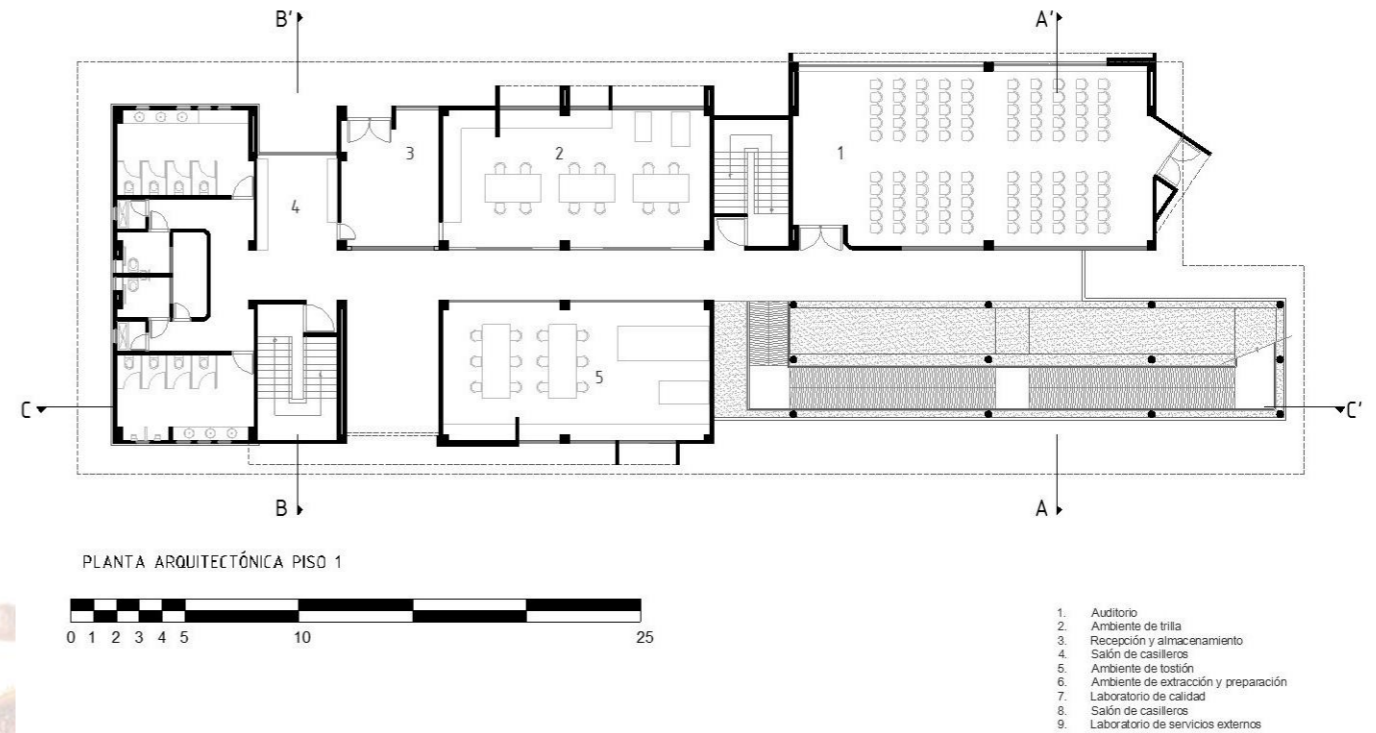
Planta arquitectónica primer nivel, fuente: Archdaily.com, 2018
